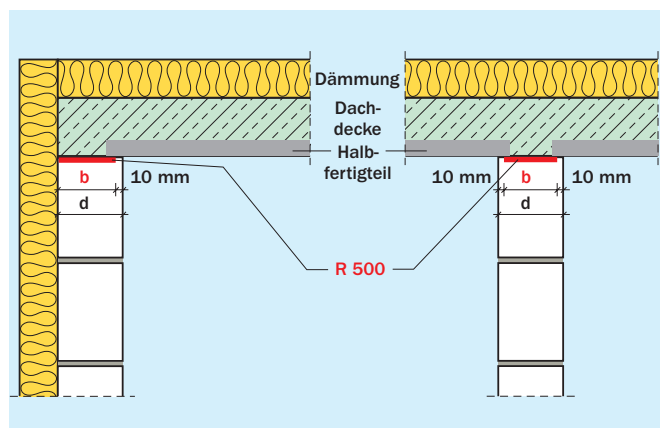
Trennschicht zur Aufnahme der Schwindverkürzung der Stahlbetondecke im obersten Geschoss unter Beibehal-tung der oberen Halterung
